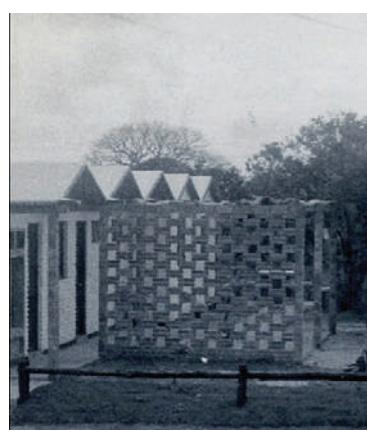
Casa com cobertura apoiada nas paredes, todos os demais elementos são de tijolo armado. (*-5).
